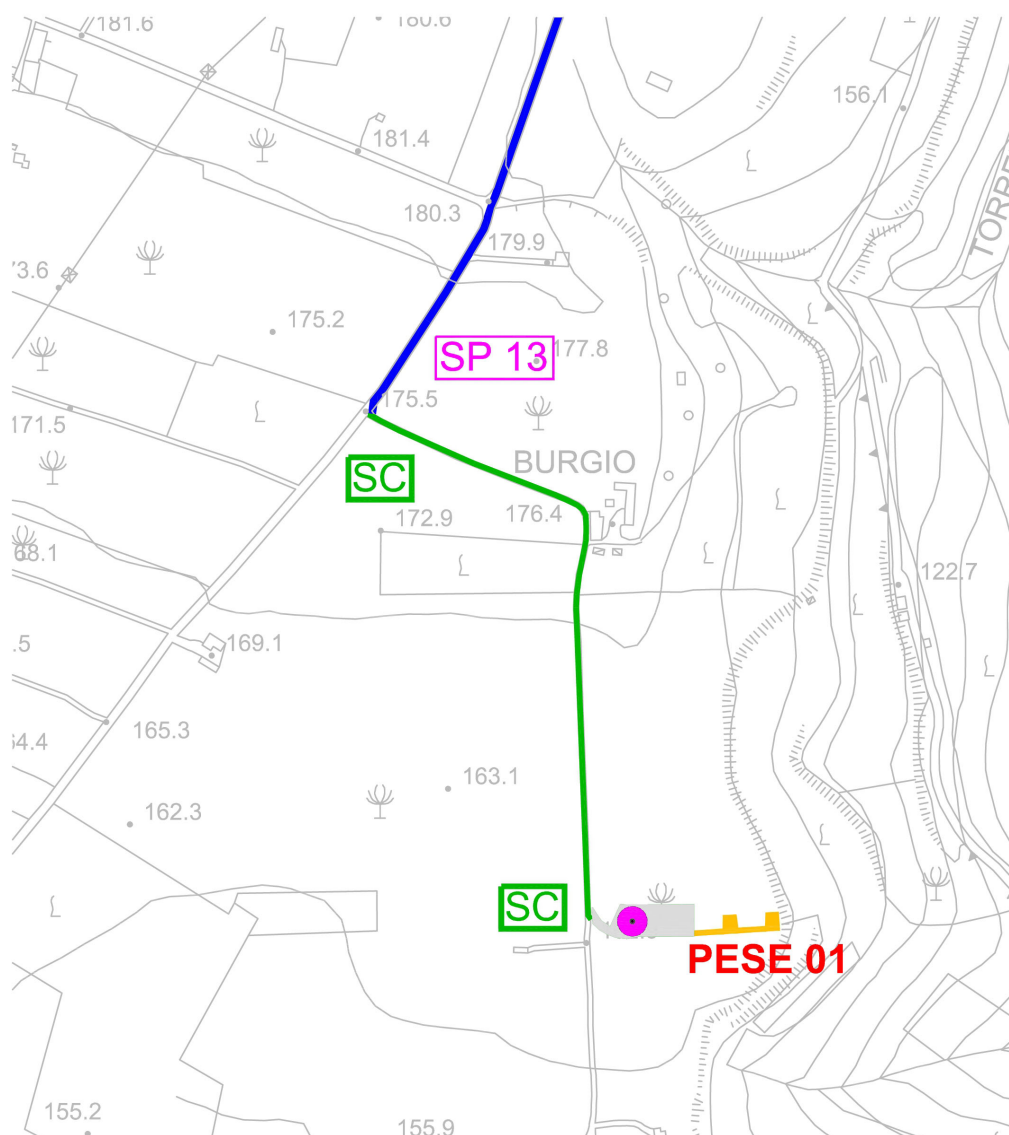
Planimetria delle strade di cantiere scala 1:5.000
